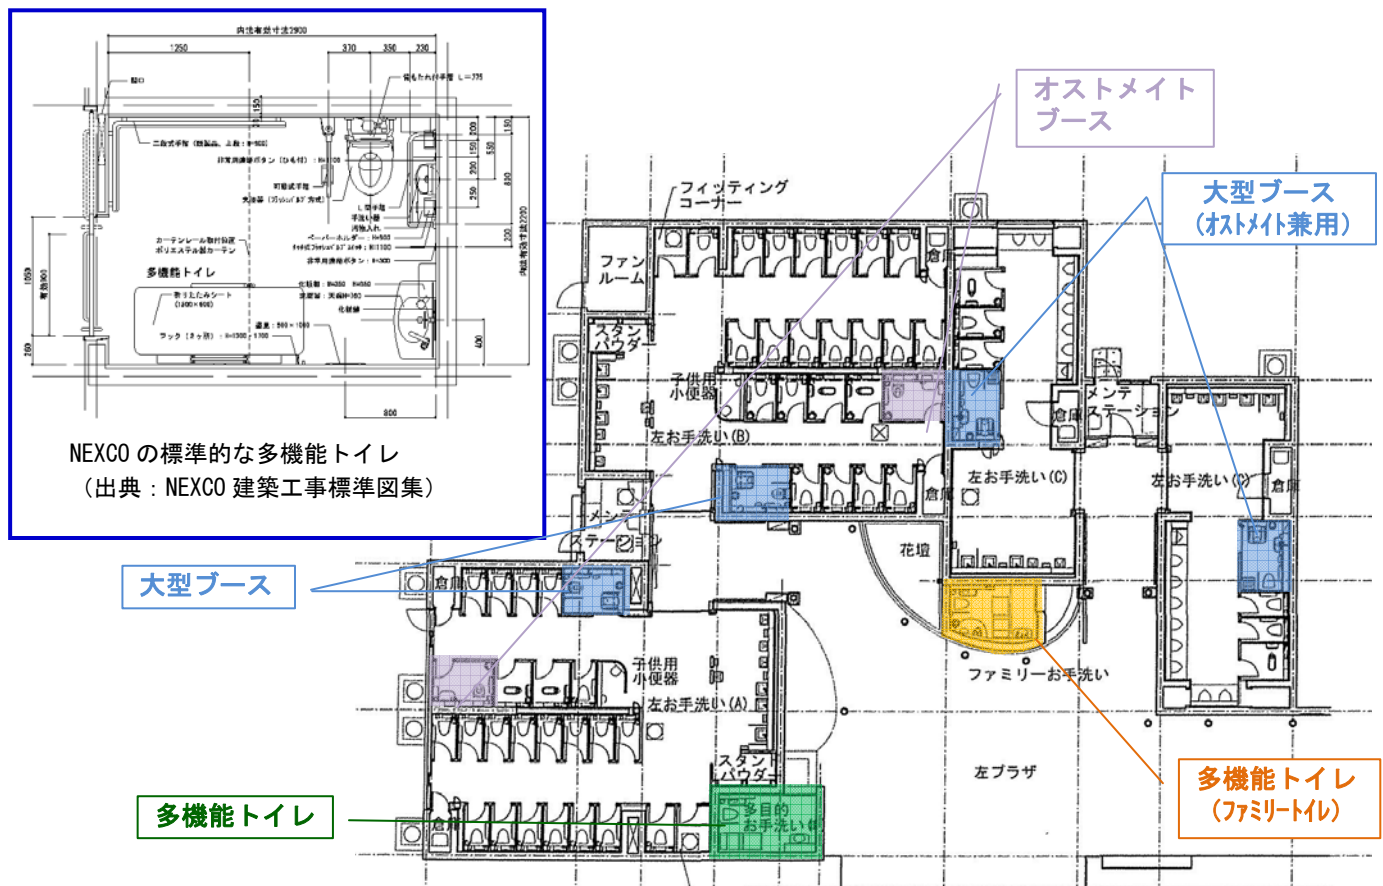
海老名 SA(下り)小型車側トイレ平面図
